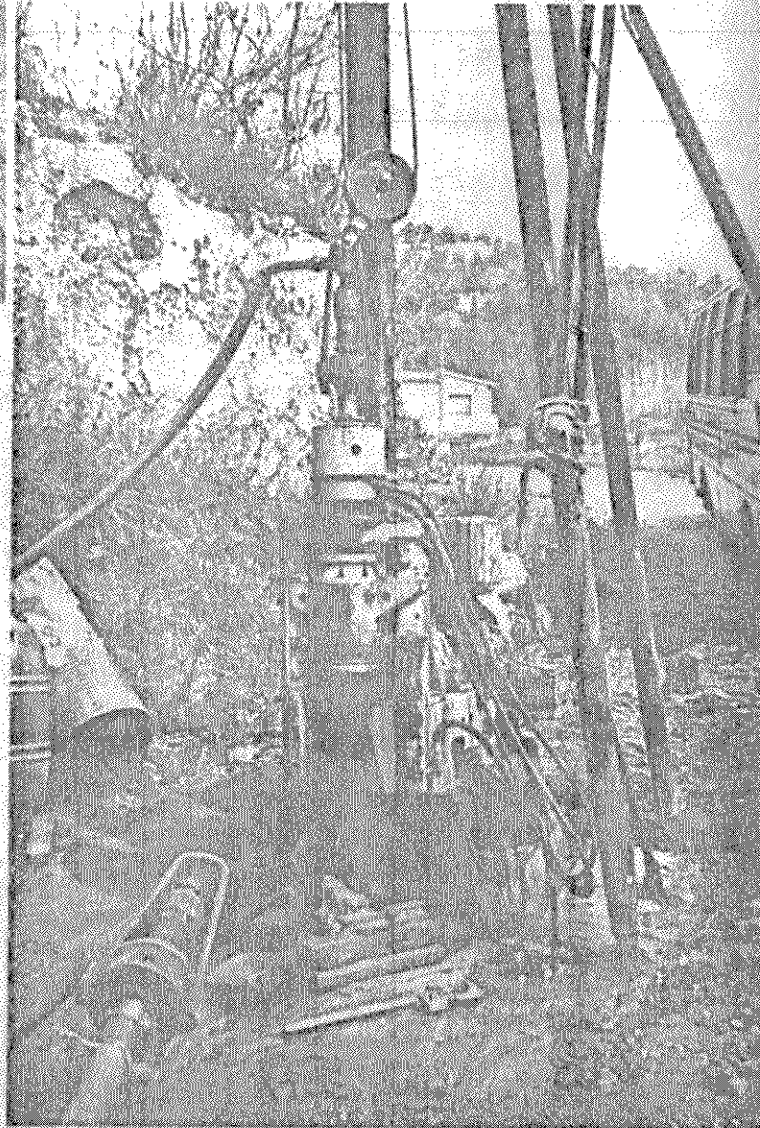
Planta potabilizadora de Playa de Aro-Provincia de Gerona.
